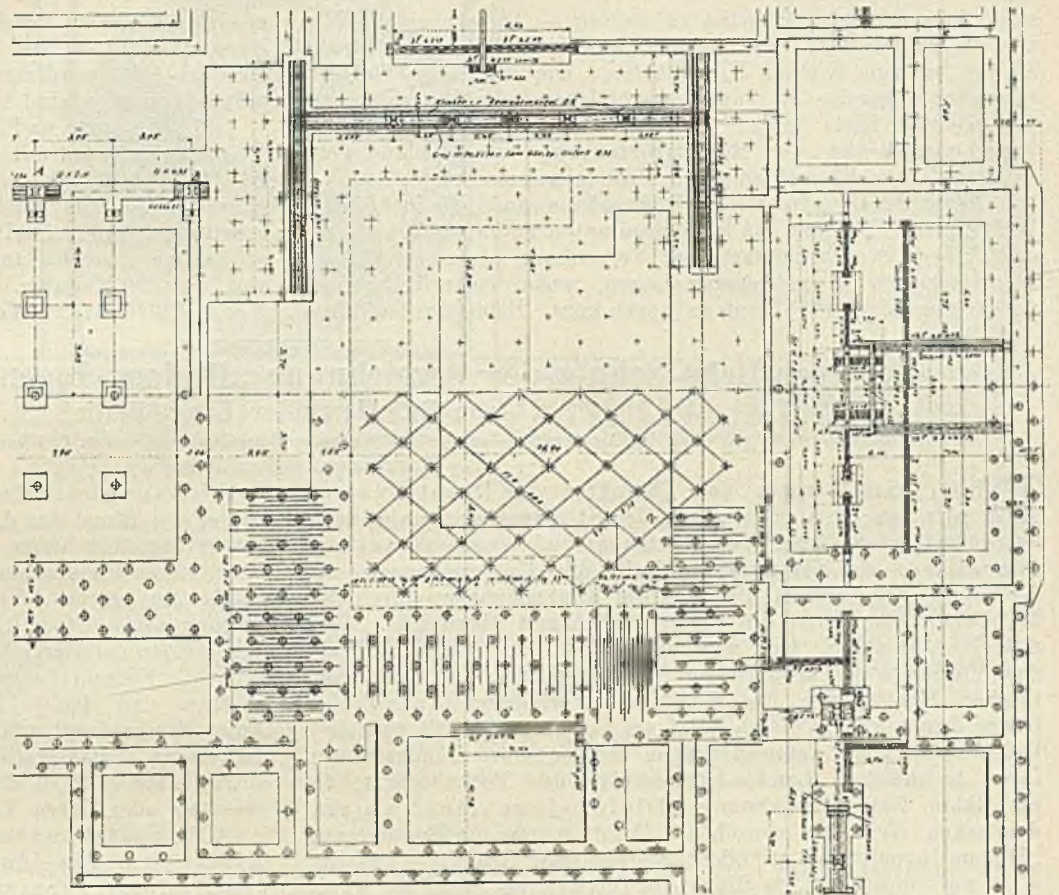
Grundriss der Fundamente und Bühnenhäuser
